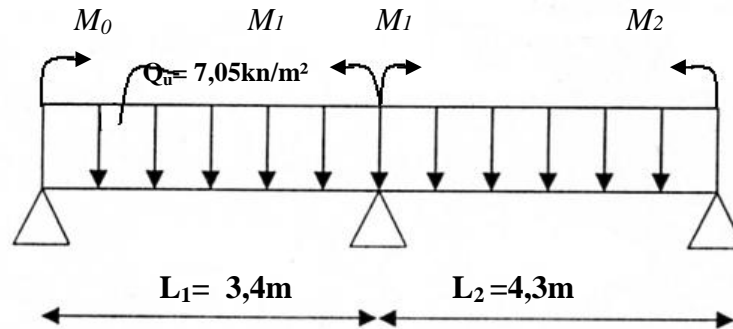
schéma statique de la poutrelle type 2 à l'ELU.
